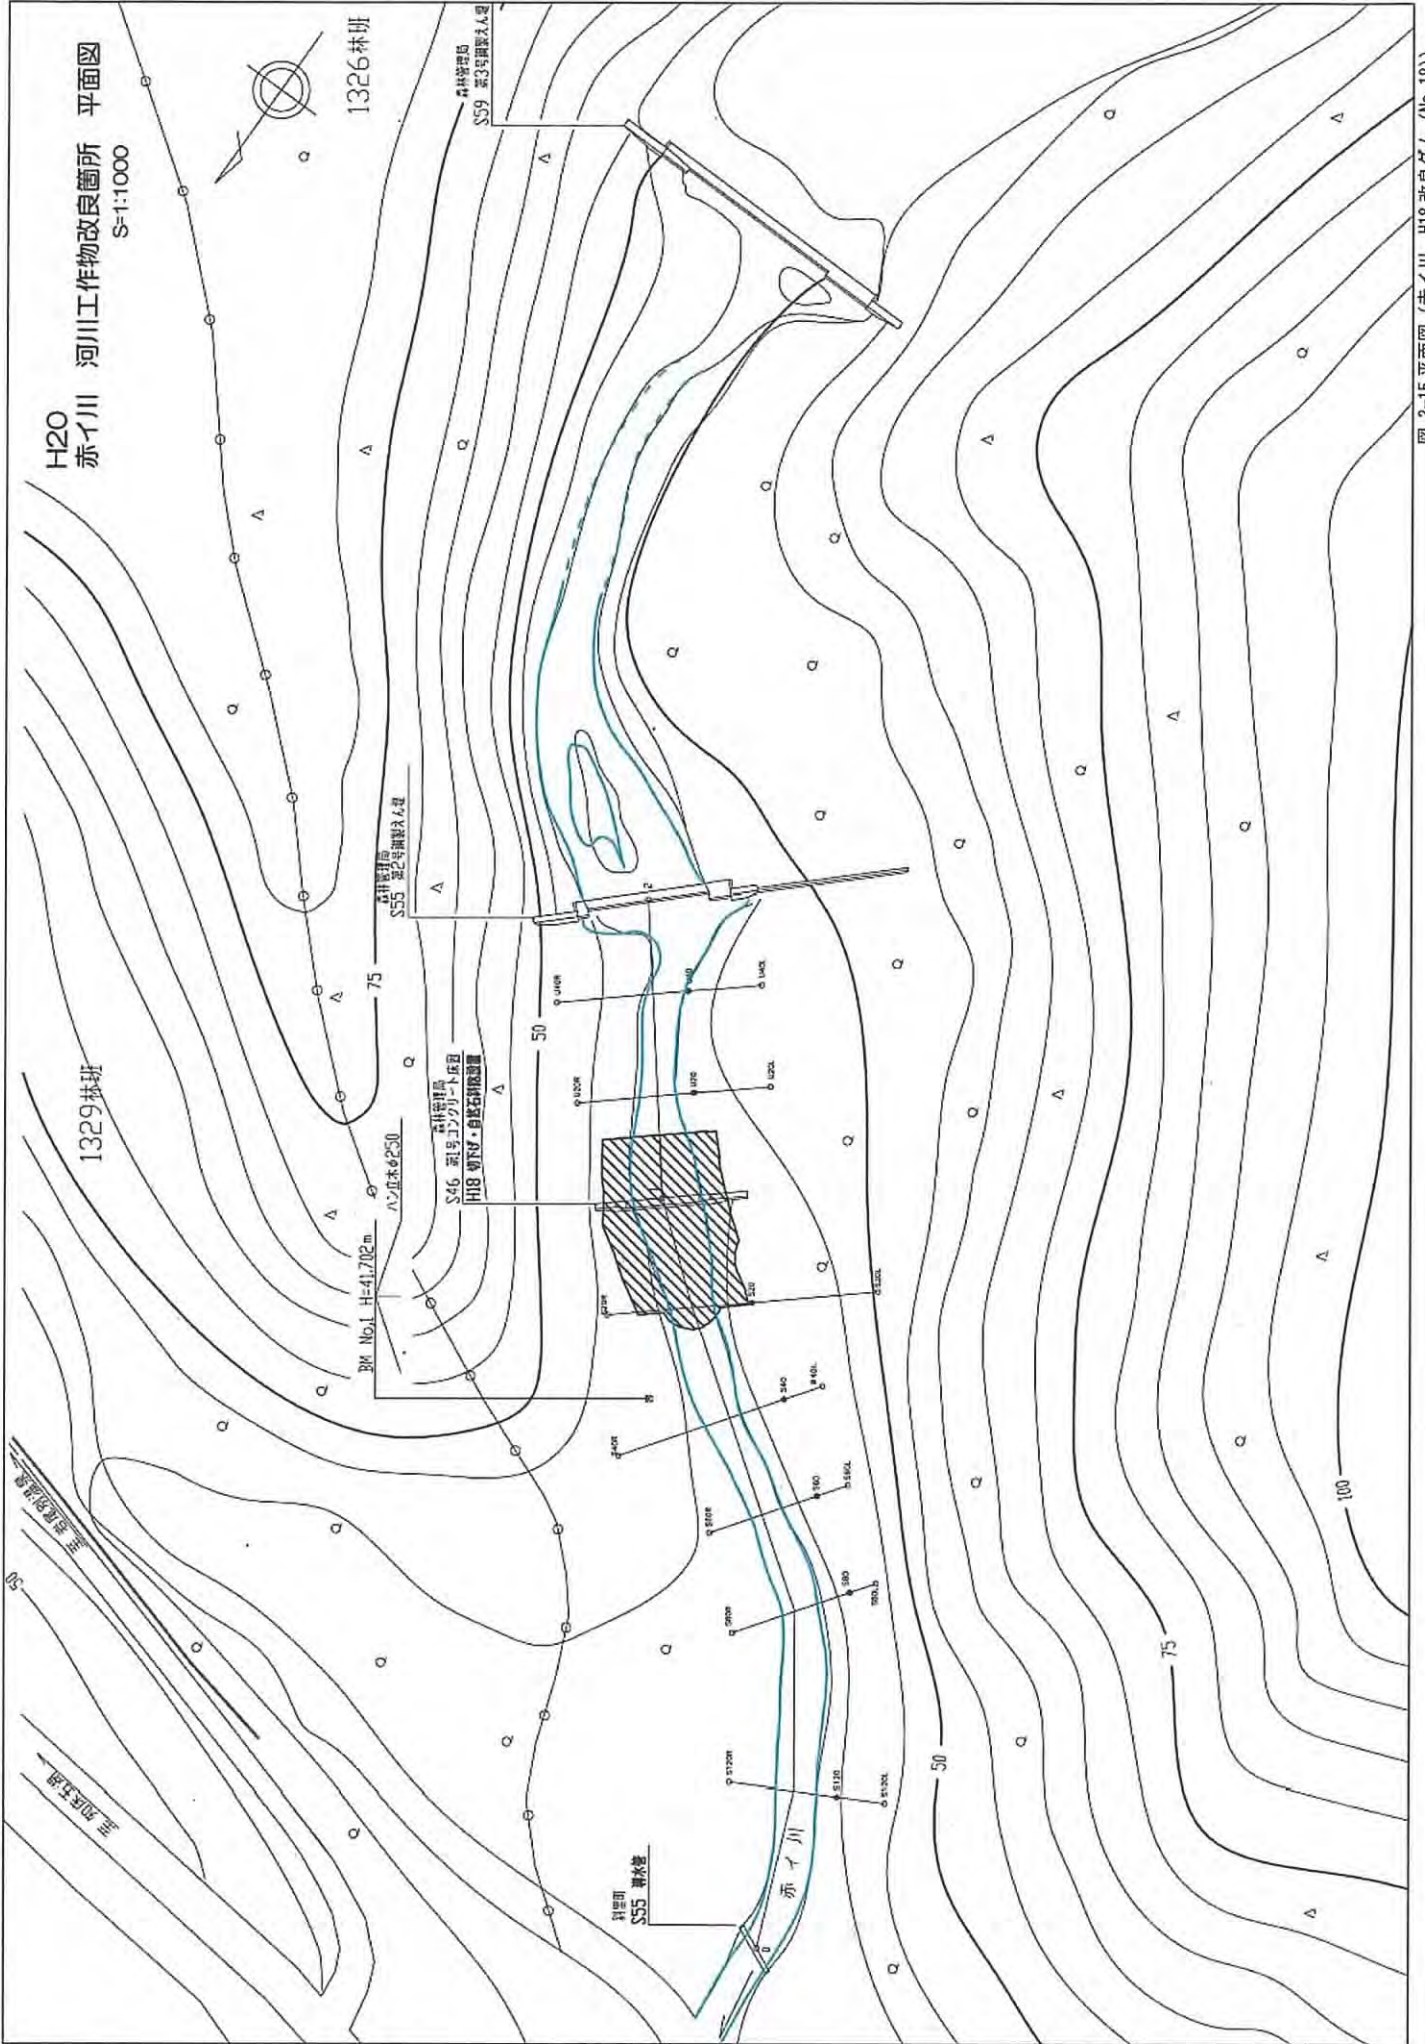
平面図 (赤イ川 H18 改良ダム (No.18))
